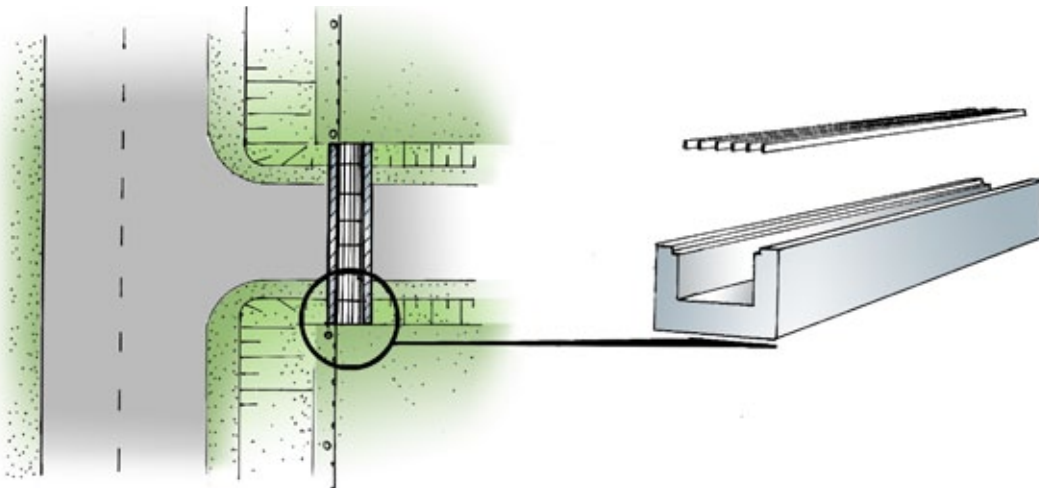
Ontwerpoplossing voor zijweg; aansluiting scherm of betonwand op roostertunnel
